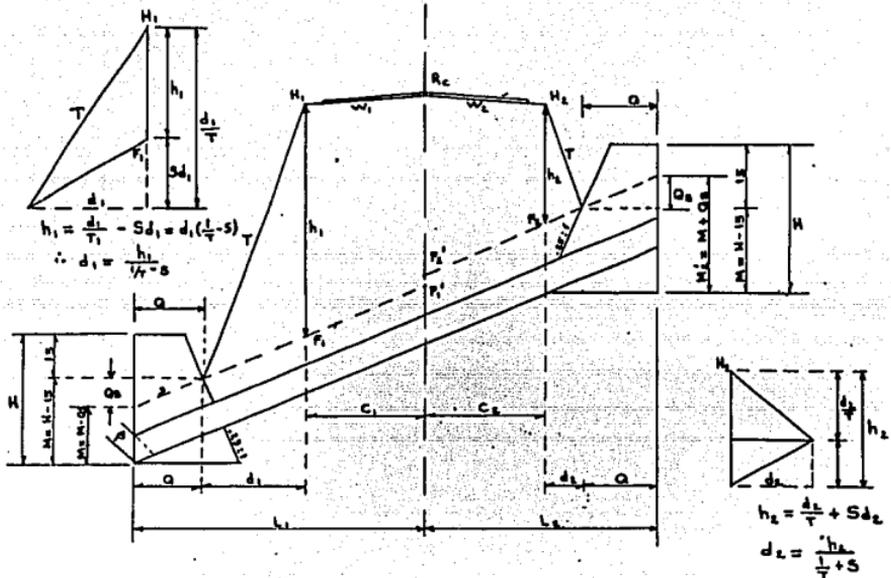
ELEMENTOS PARA EL CALCULO DE LONGITUD DE LAS ALCANTARILLAS
